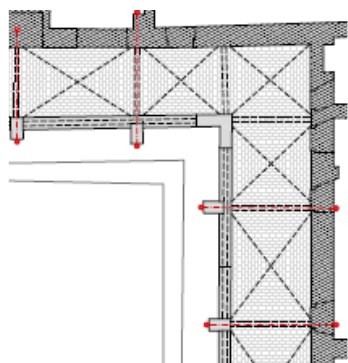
Excerto da planta de localização dos tirantes ao nível do primeiro piso
